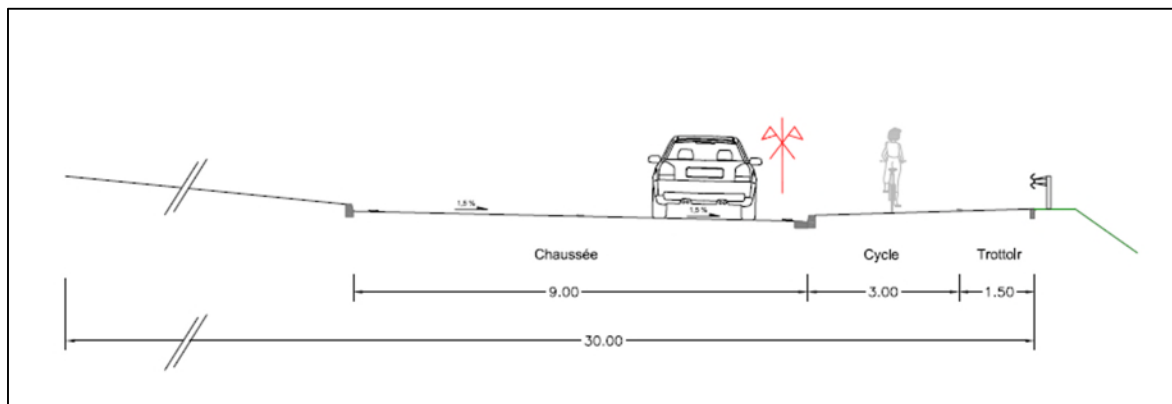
Profil en travers type au niveau du giratoire avenue Pierre Mendès France
